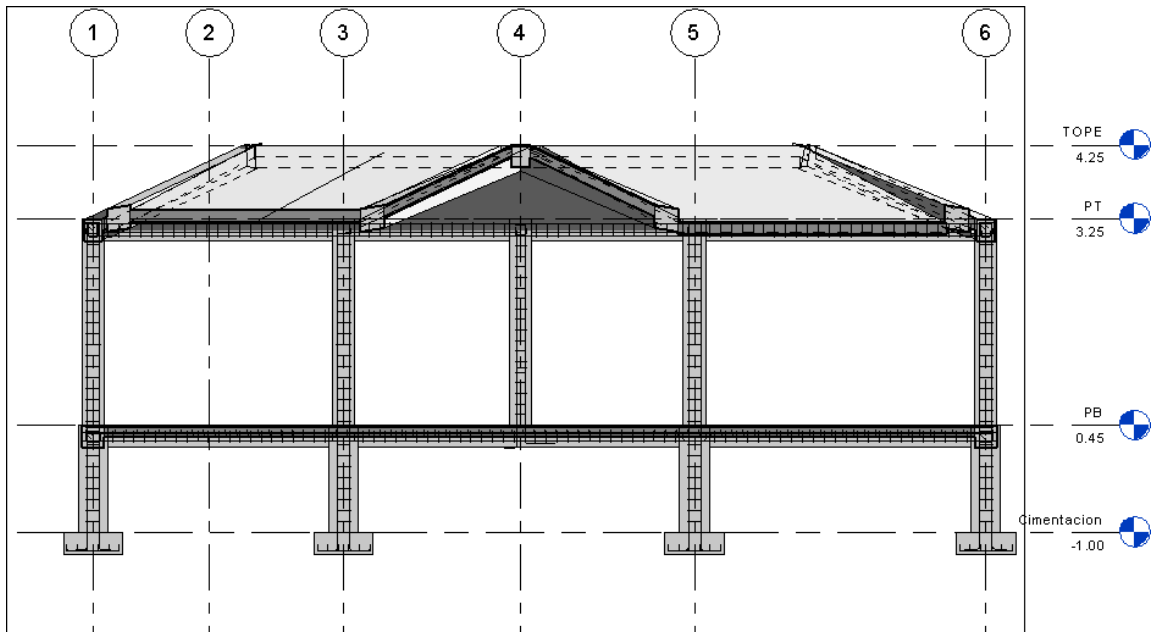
Vista 3D del modelo estructural de concreto armado de la capilla en estudio.
